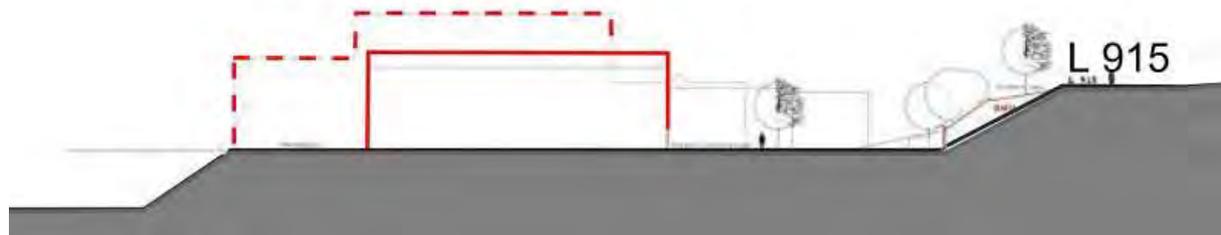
Höhe der vorhandenen Halle (rot durchgezogene Linie) und im Hintergrund die nördlich davon geplante Montagehalle (rote Strichellinie) (Entwurf: +SEELINGER Architekten+Ingenieure, Bearbeitung: Doris Vielhaber, Stand 10.03.2022)
